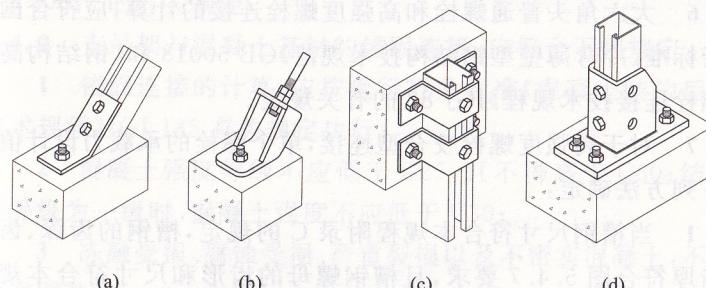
钢构件与混凝土结构之间的连接示意
